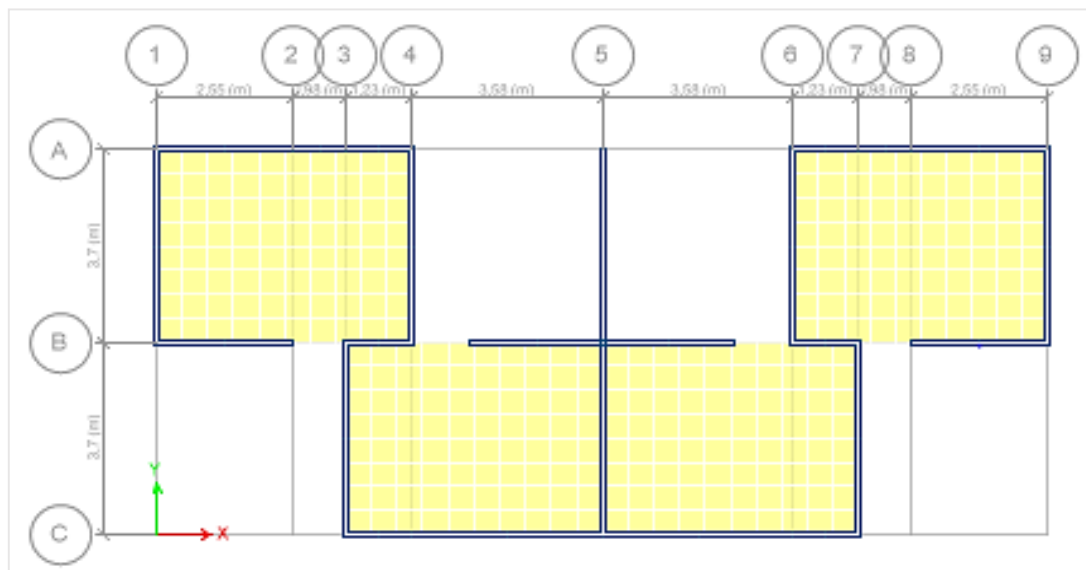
Muros Segunda planta de Conjunto de casas C82. Nivel N+4,90
